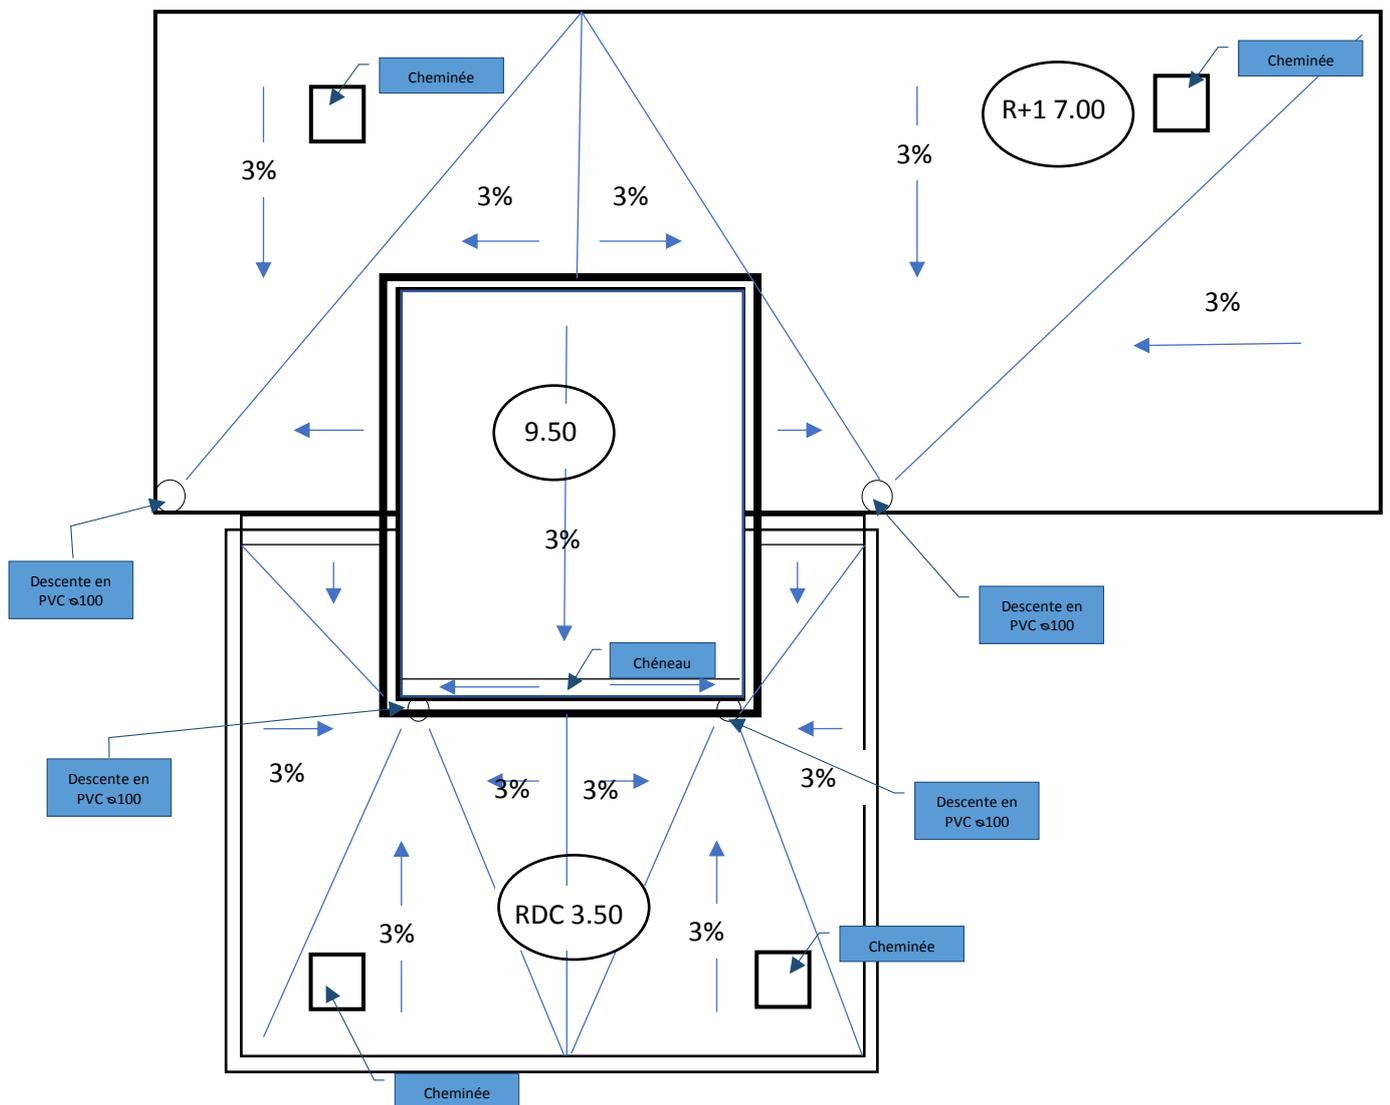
Exemple de représentation d'un toit terrasse non accessible
